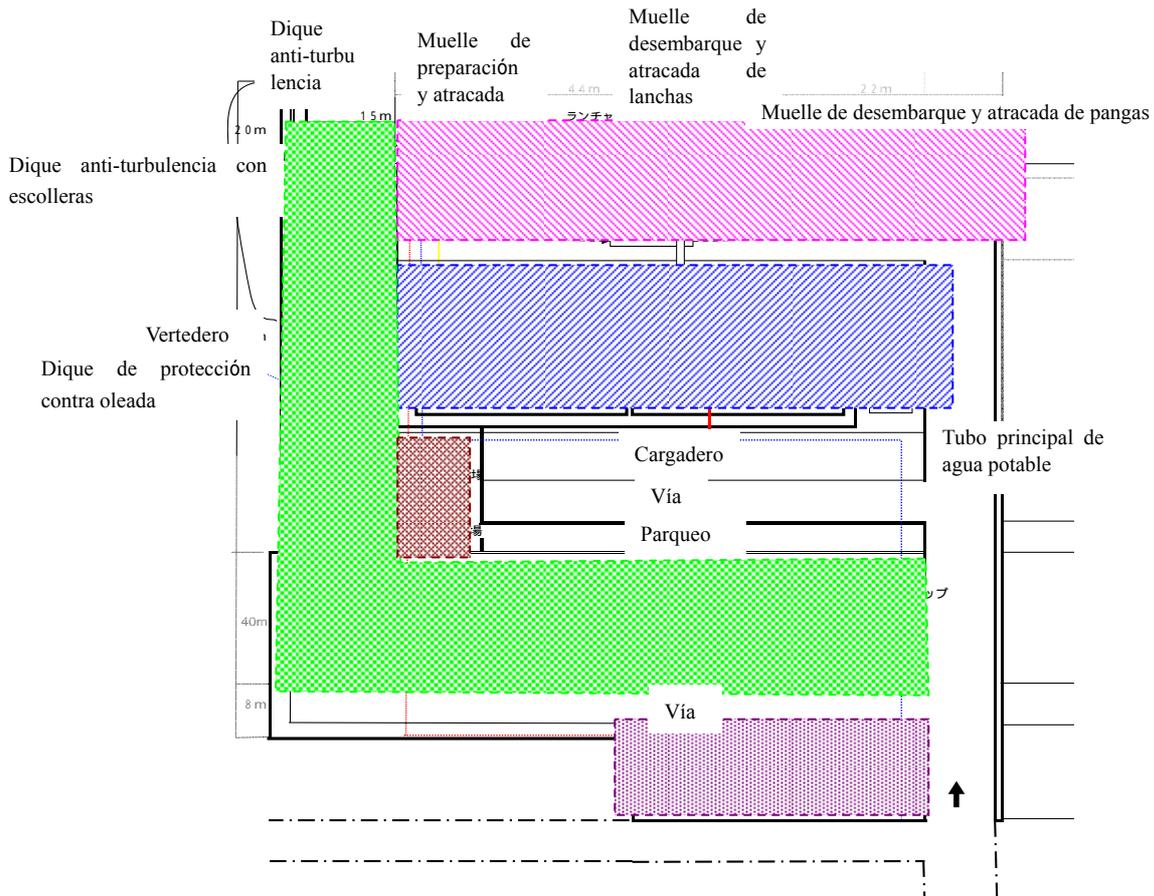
Plan de disposición de funciones e instalaciones
